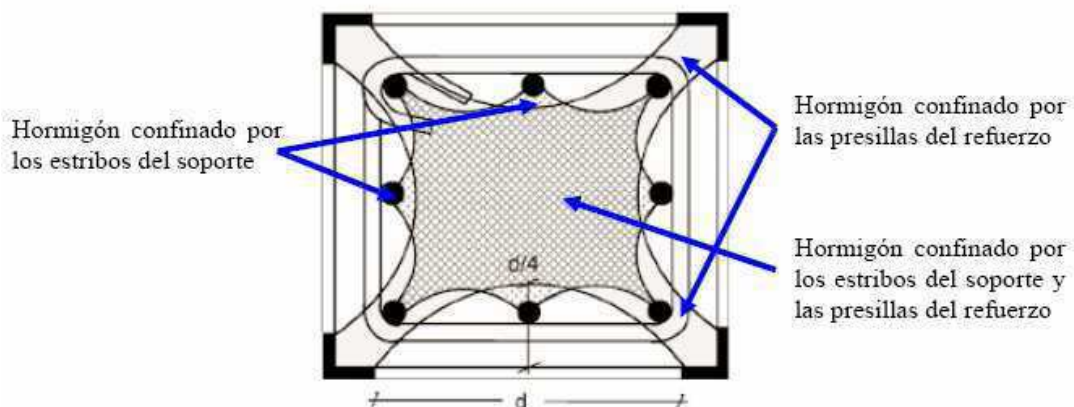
Confinamiento del hormigón en una sección reforzada, teniendo en cuenta el confinamiento por estribos y por el refuerzo (Montuori y Piluso 2009)
